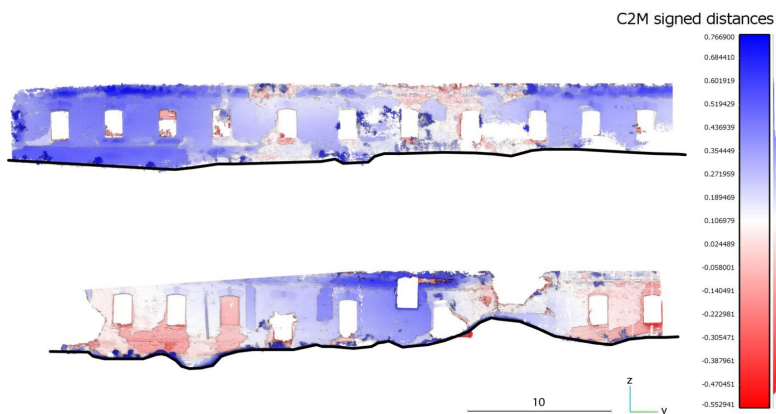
Определение отклонений от вертикали для длинных фасадов варницы
